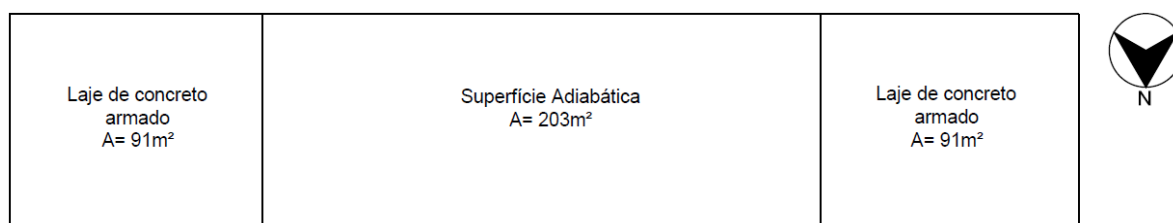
Teto das zonas do décimo quinto pavimento
